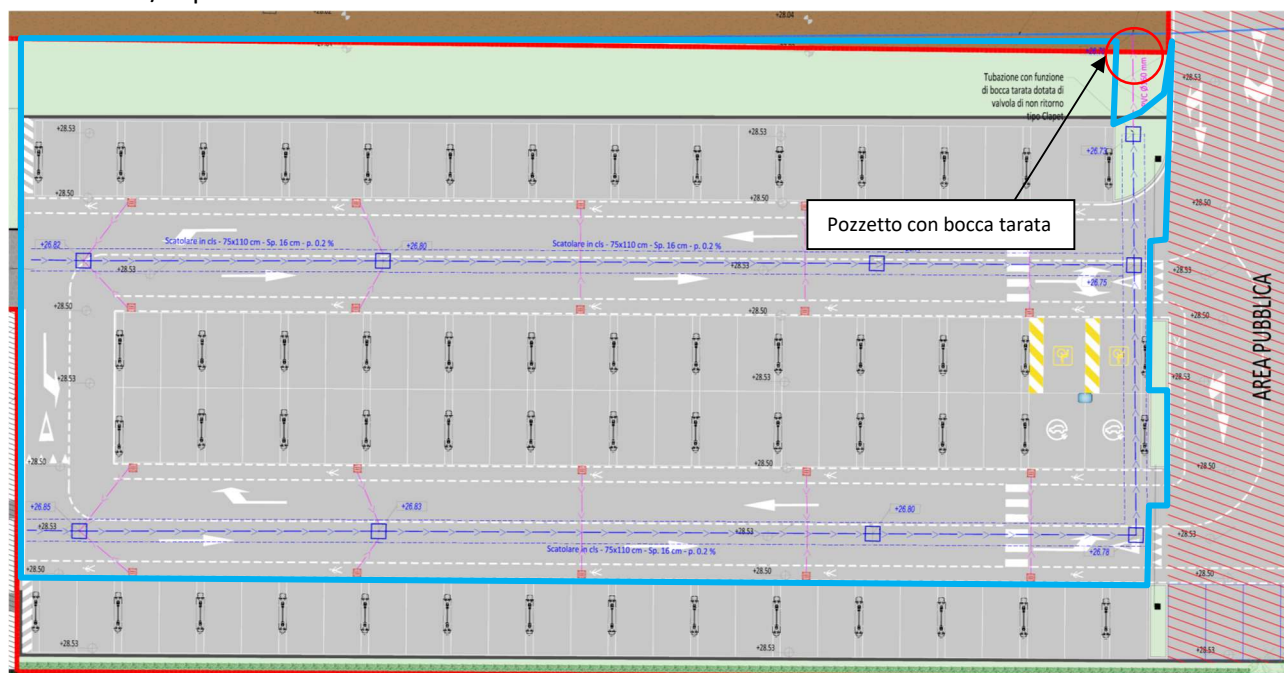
Planimetria reti di smaltimento acque meteoriche parcheggio privato
